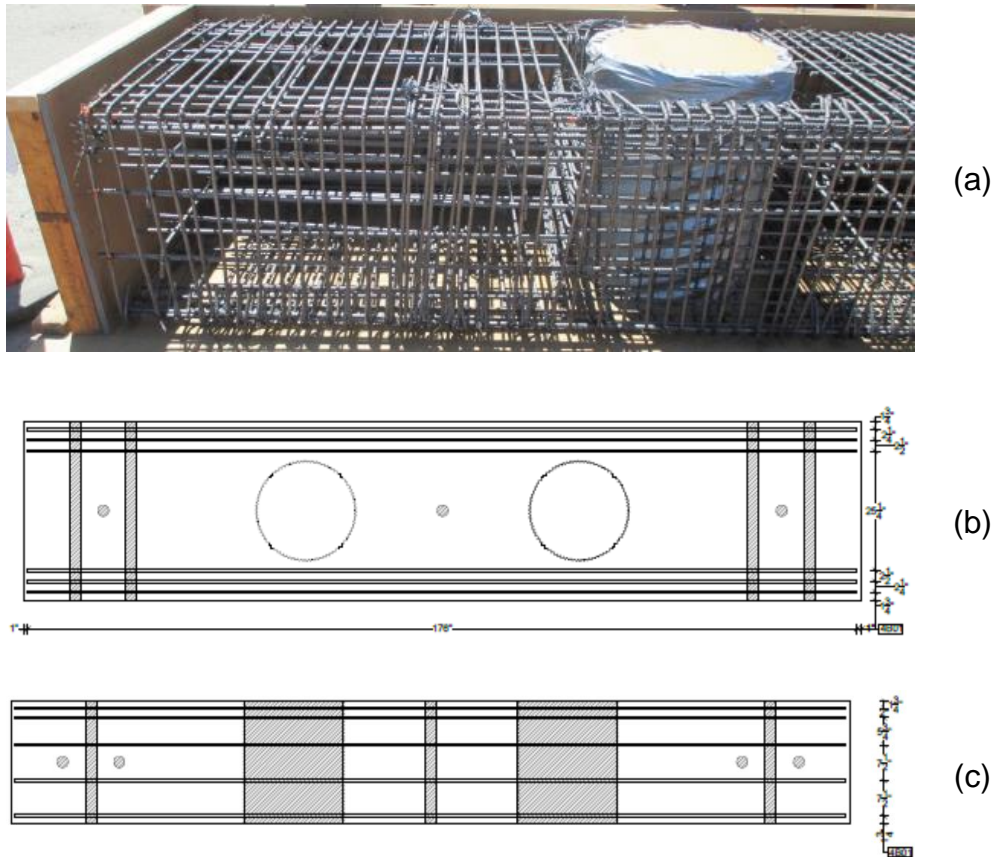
Particolare delle armature (a), sezione orizzontale (b) e sezione verticale (c) del blocco di fondazione (Blind prediction contest, 2017). / Longitudinal rebars (a) and horizontal (b) and vertical (c) sections of the foundation (Blind prediction contest, 2017).
